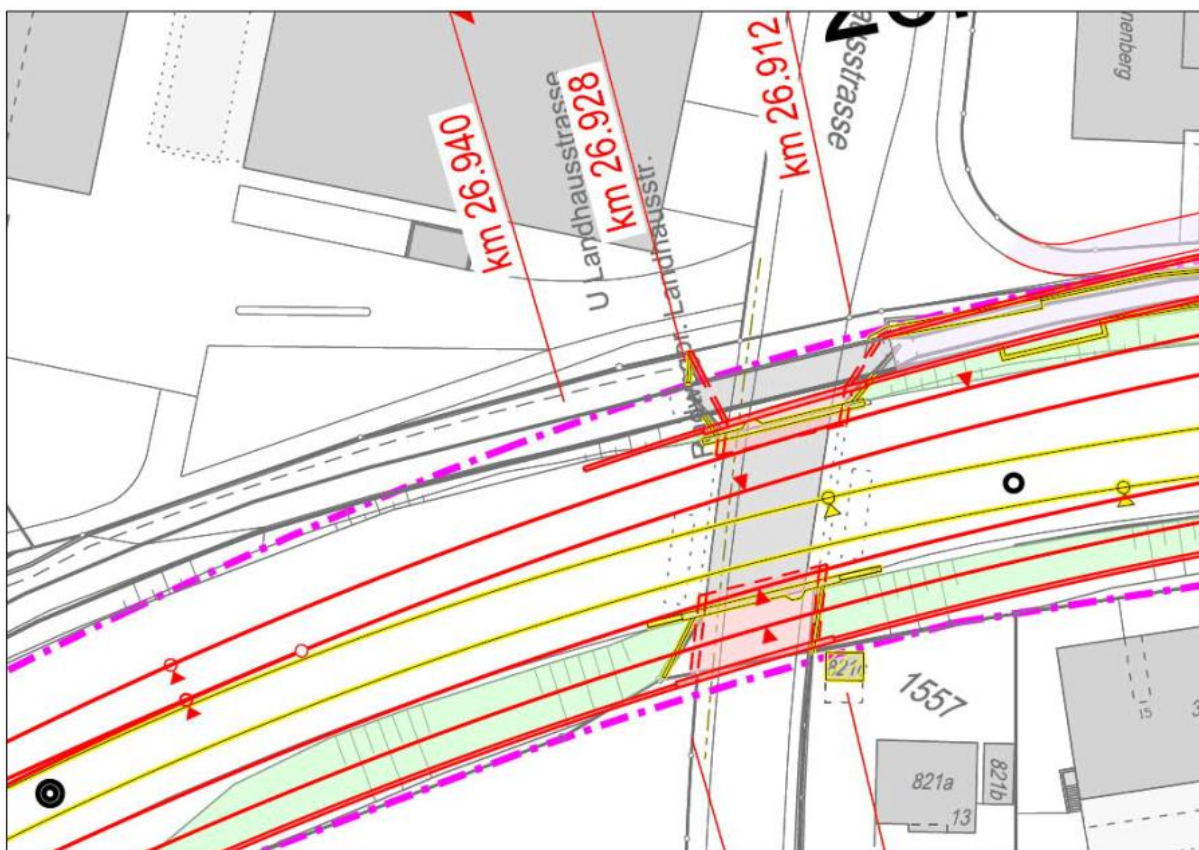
Situation Strassenunterführung Landhausstrasse [1]
